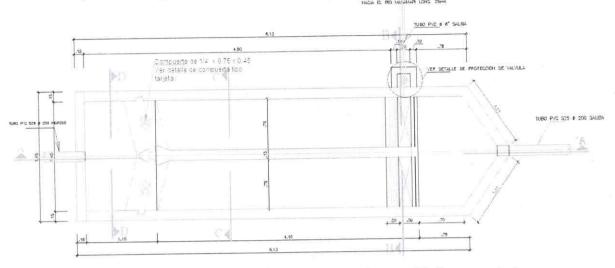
Vista en Planta del Desarenador de Alcantarillado proyectado
